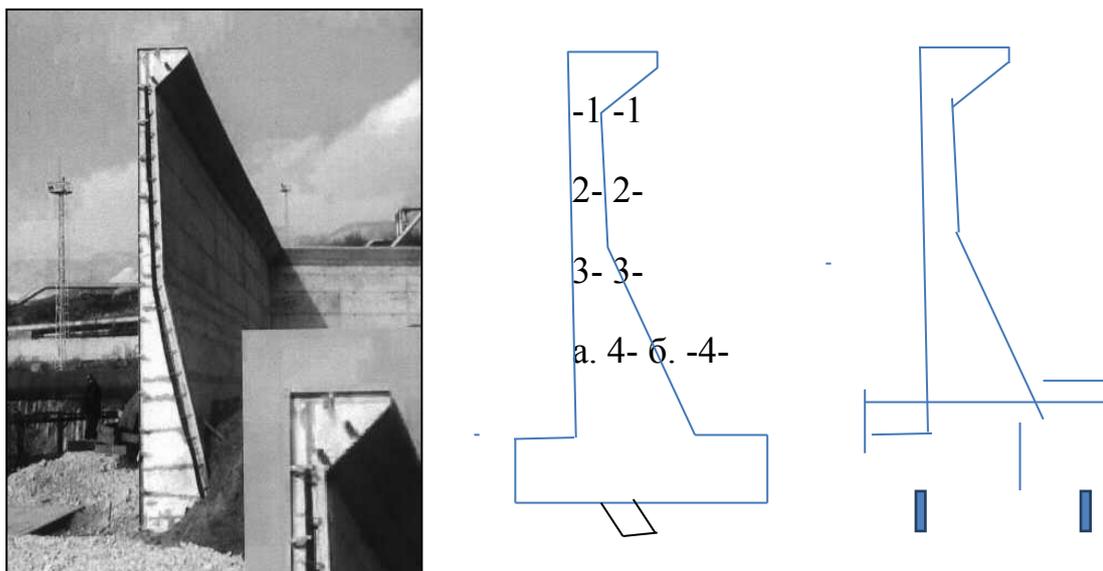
Общий вид защитной стены с отбойным козырьком для вертикальных стальных резервуаров ВСП-30000 на нефтебазе «Шесхарис» г. Новороссийска (а) и разработанная (б). 1 – козырек, 2 – вертикальная стена, 3 – фундамент, 4 – железобетонный выступ.
